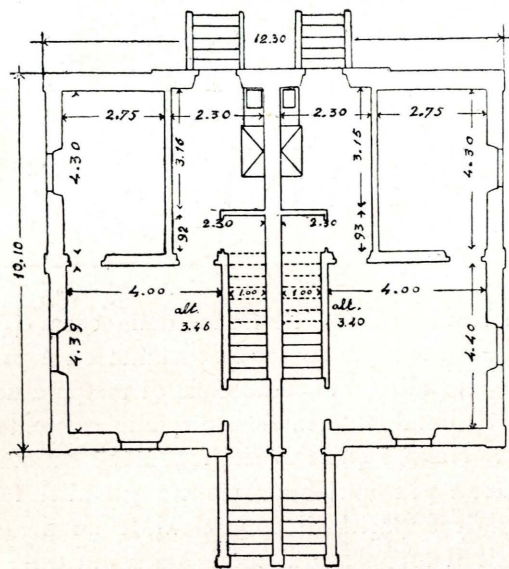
Pianta piano terreno (Scala 1 : 200).
